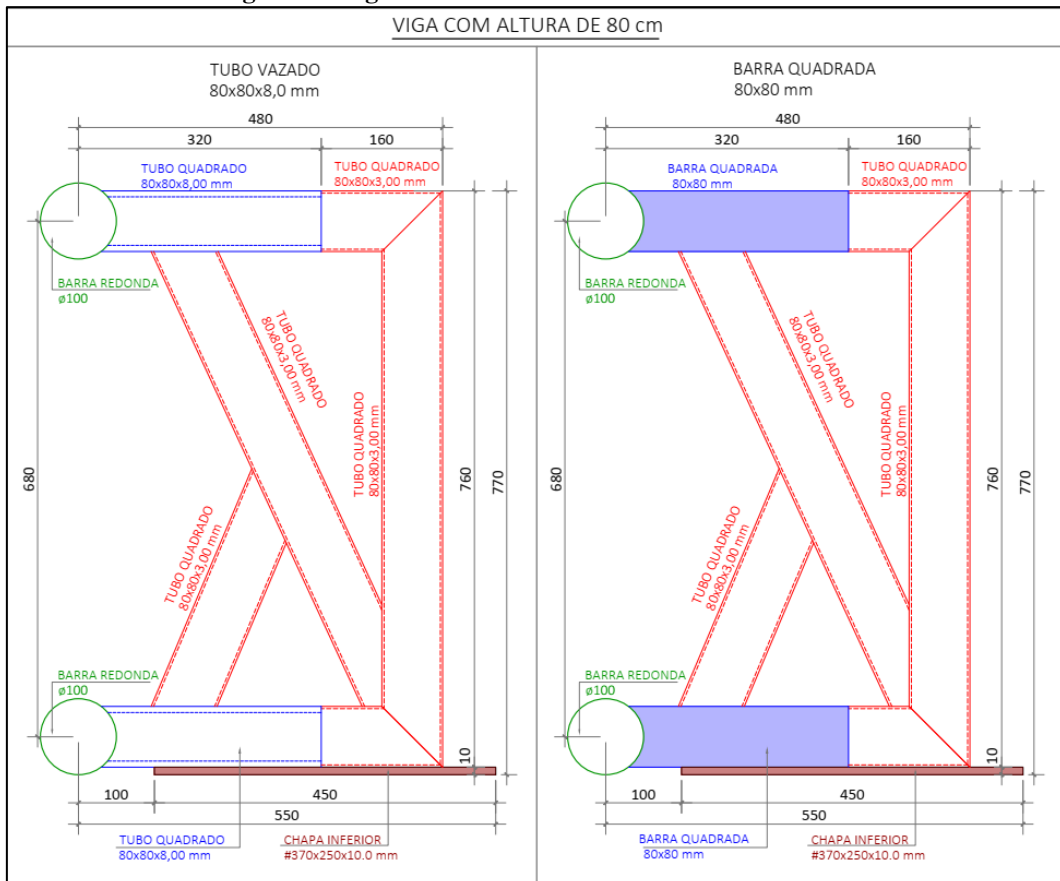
Viga 30x80 - Tubos e barras metálicas 80 mm
